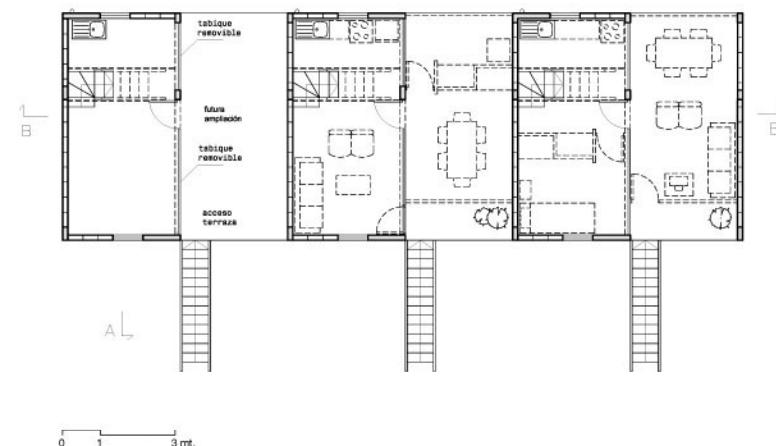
Plantas baixas 1º pavimento das unidades de 2 pavimentos.
